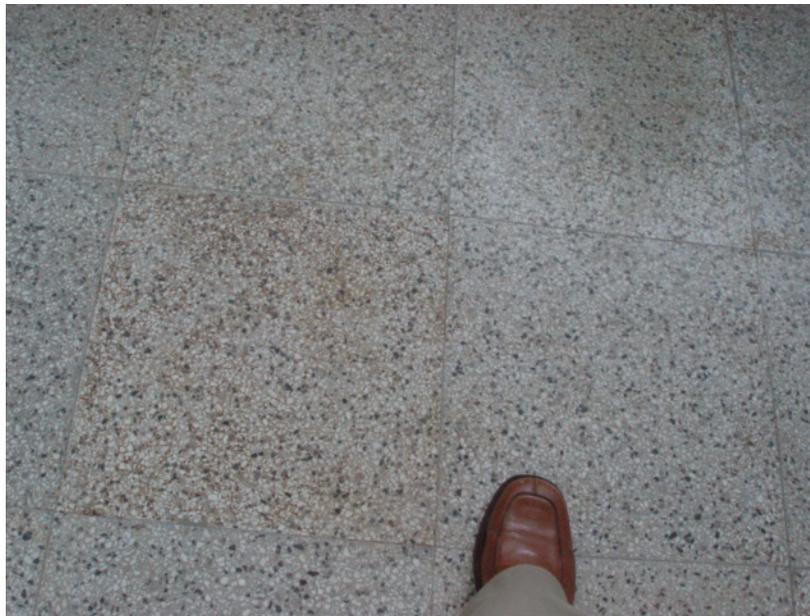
Obra VI: Piso de granito reconstituído. Baldosas con descacaramiento.
